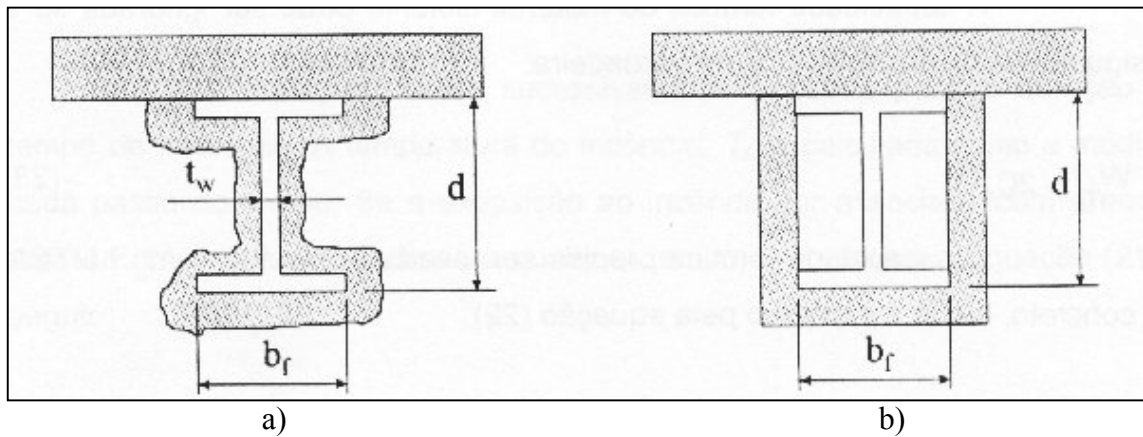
(a) Proteção tipo contorno e (b) Proteção tipo caixa, aplicados à uma viga I sobreposta por laje de concreto.
